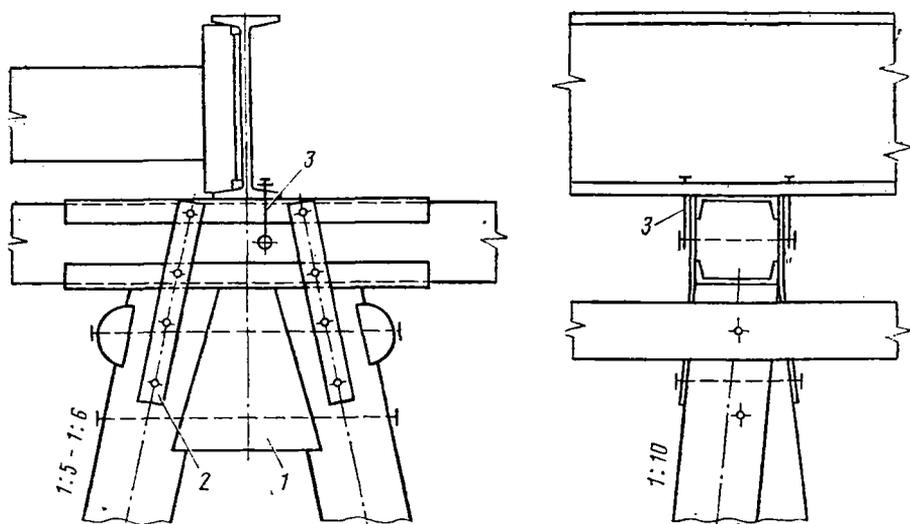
Соединение наклонных деревянных свай с насадкой
